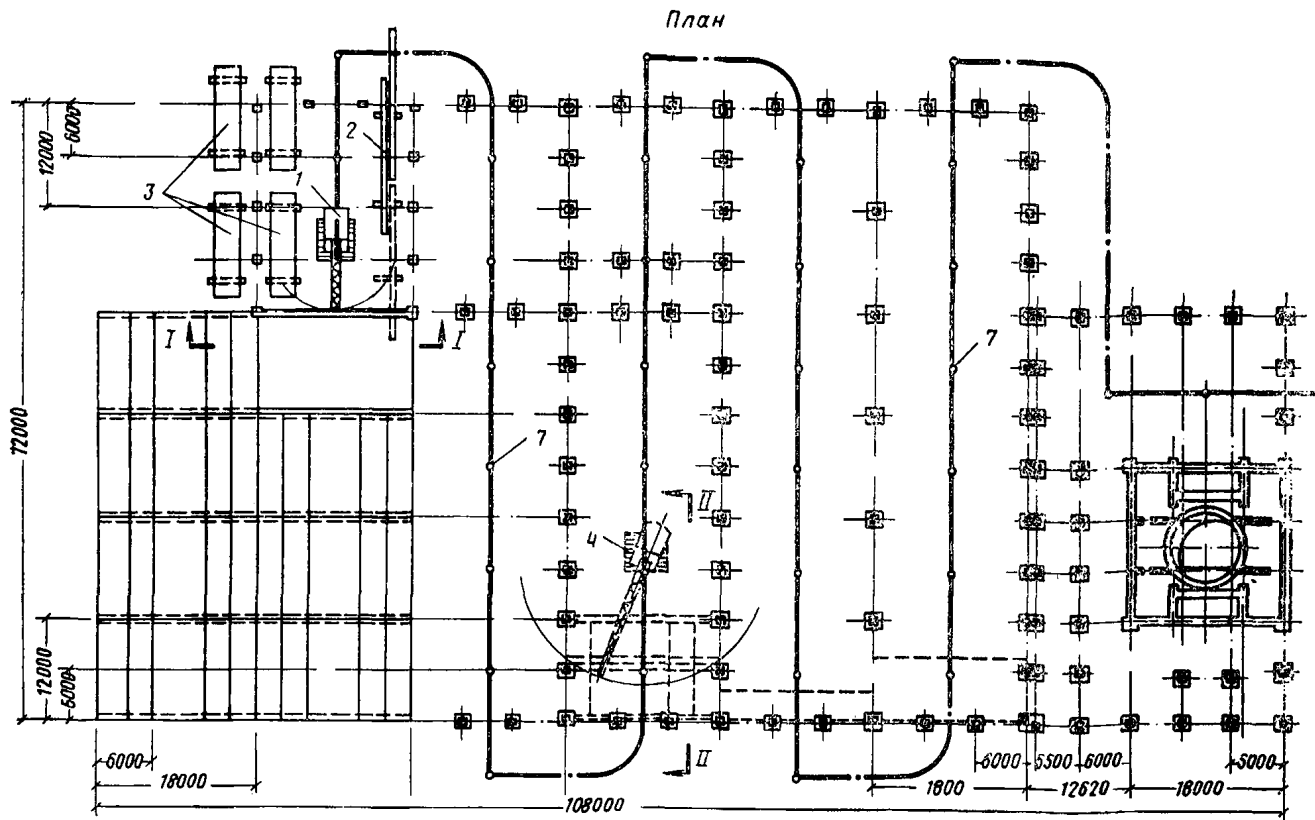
Монтаж сборных железобетонных конструкций блока вспомогательного ствола
